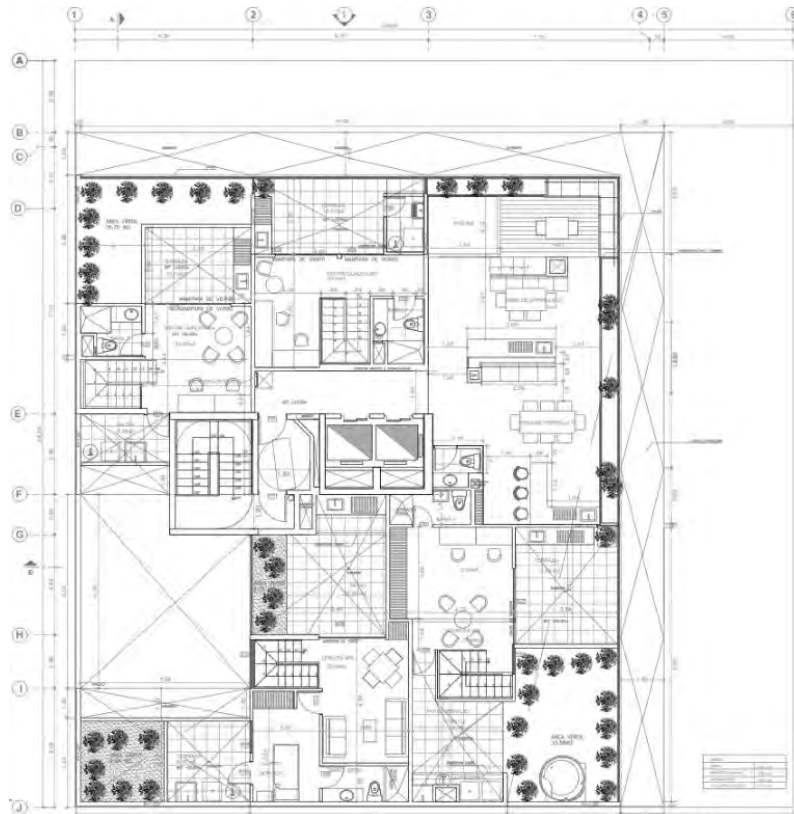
Planta azotea. Fuente: Edición propia planos por EE Inmobiliaria
